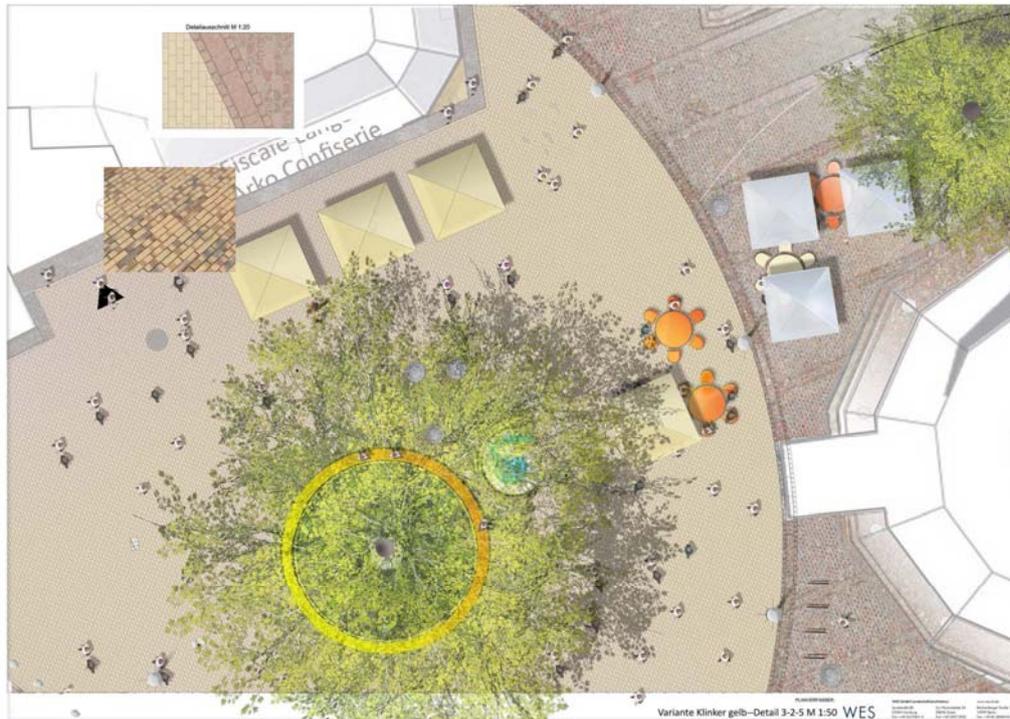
Detail Pflaster Eingangsbereich Lütjenstraße
